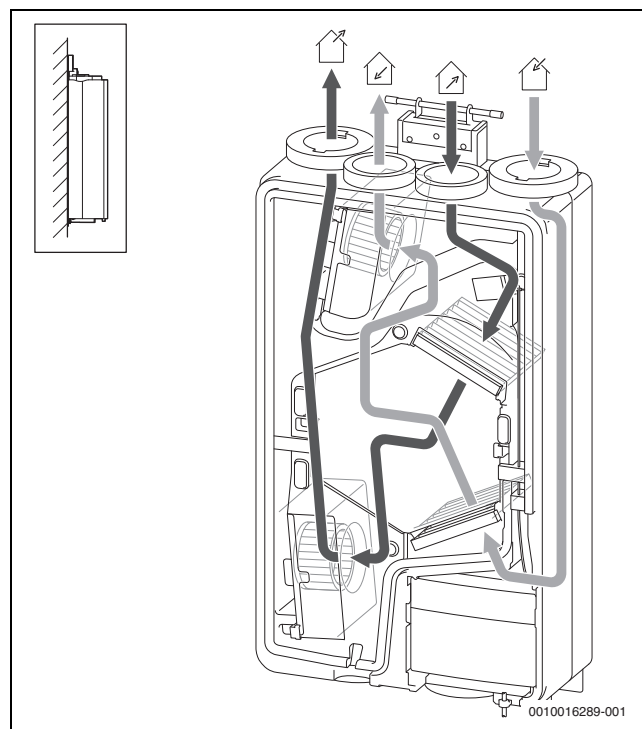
Collegamento dell'apparecchio lato aria in caso di installazione alla parete
